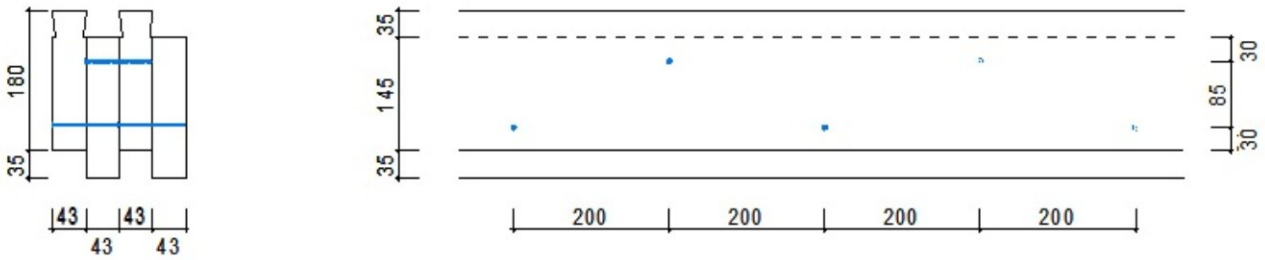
Chaînage du plancher LIGNADAL sur mur ossature bois en zone sismique
